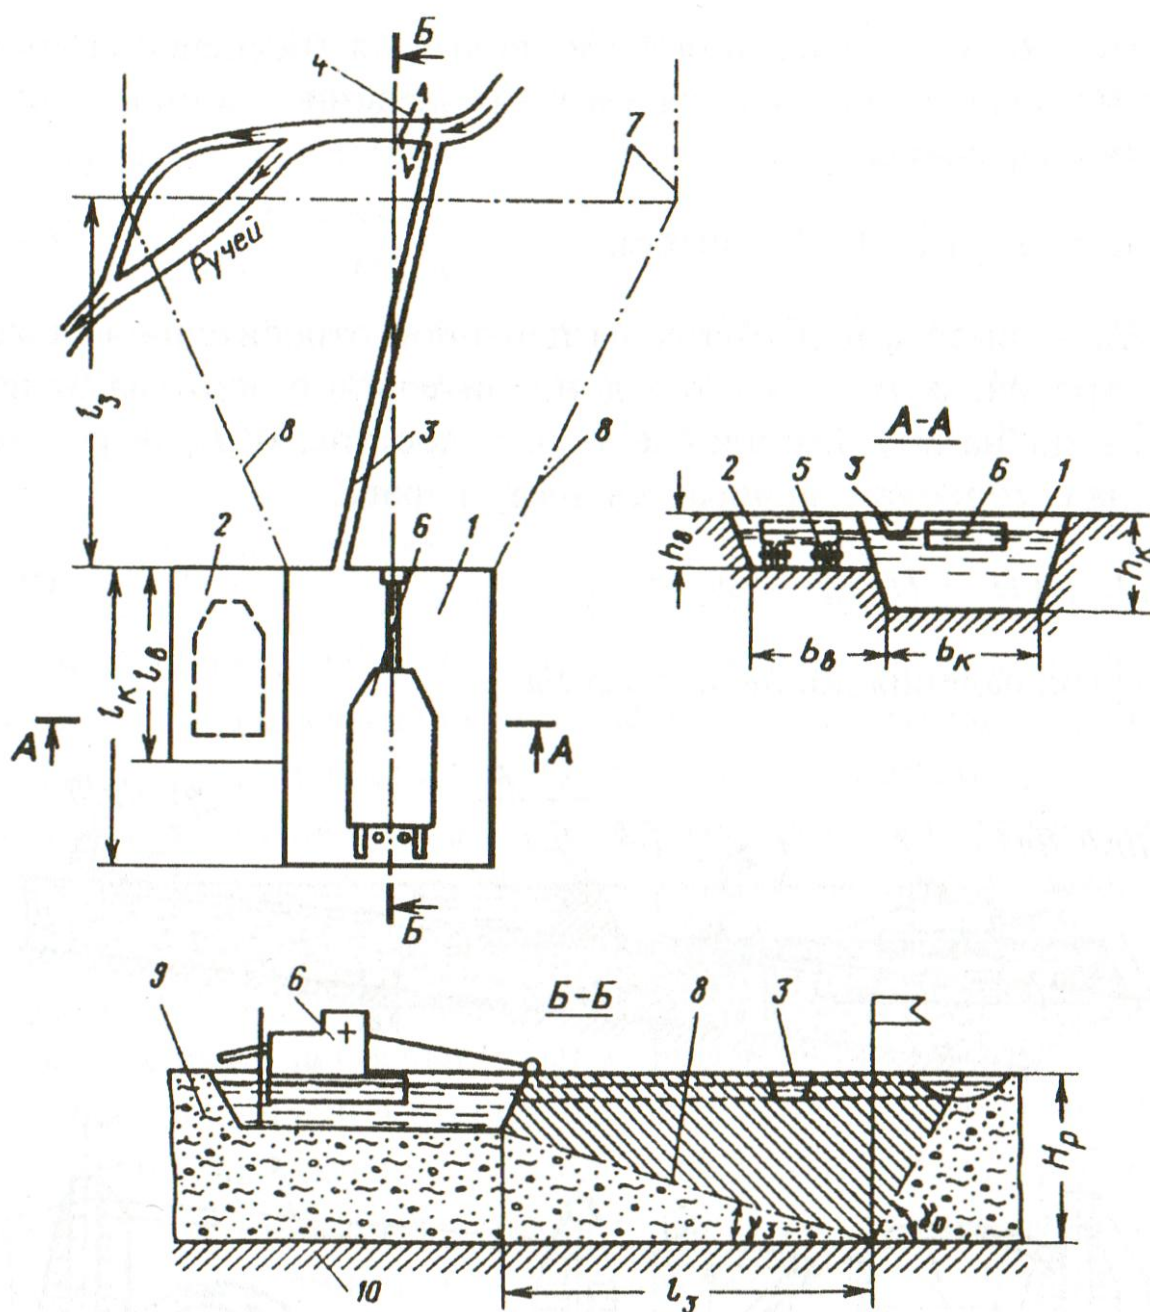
Схема вскрытия россыпи котлованом:
